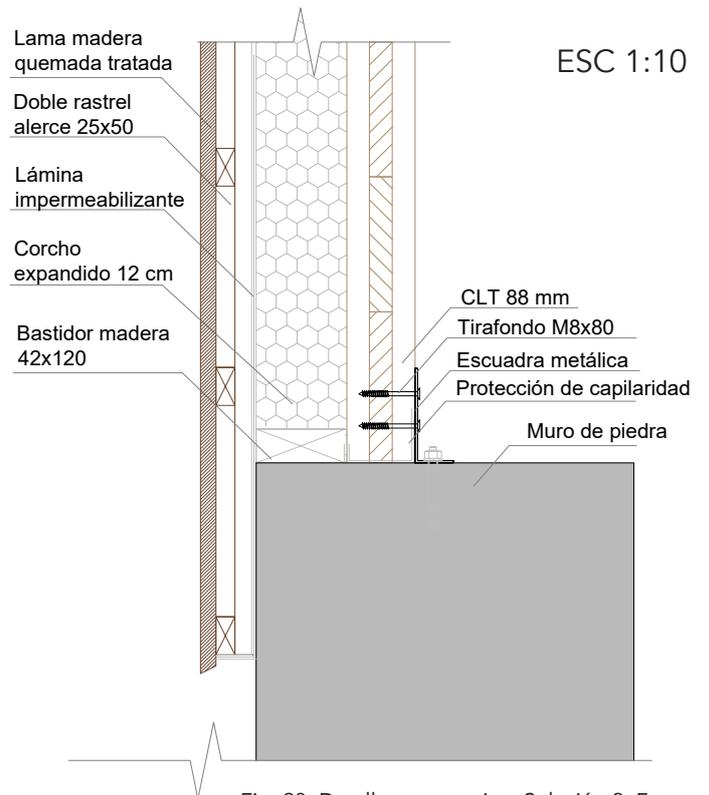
Detalle constructivo. Solución 2. Fuente: Elaboración propia
